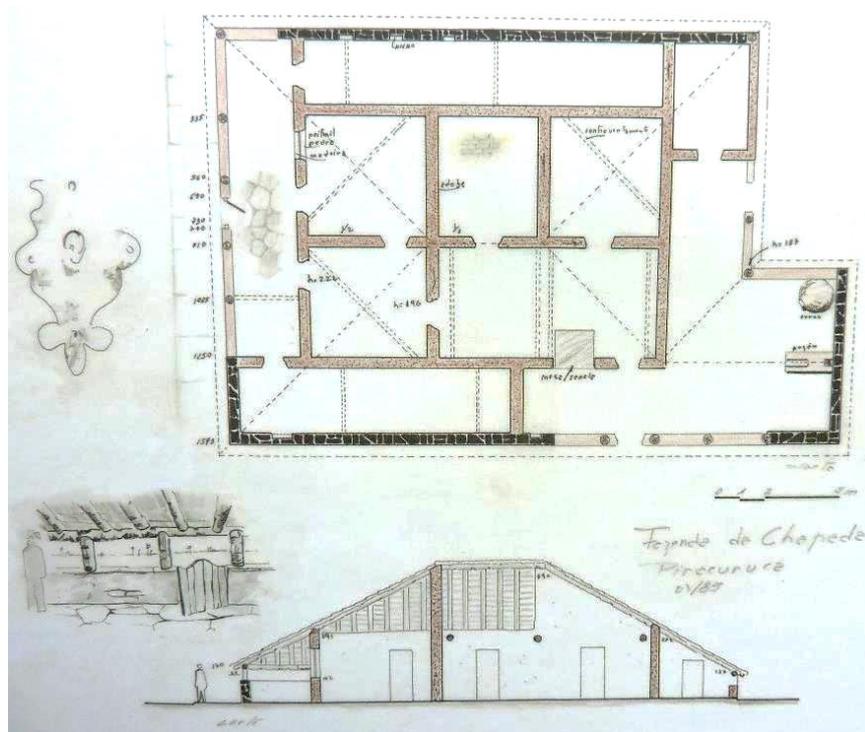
Vista da casa do vaqueiro (demolida). Fazenda Chapada
